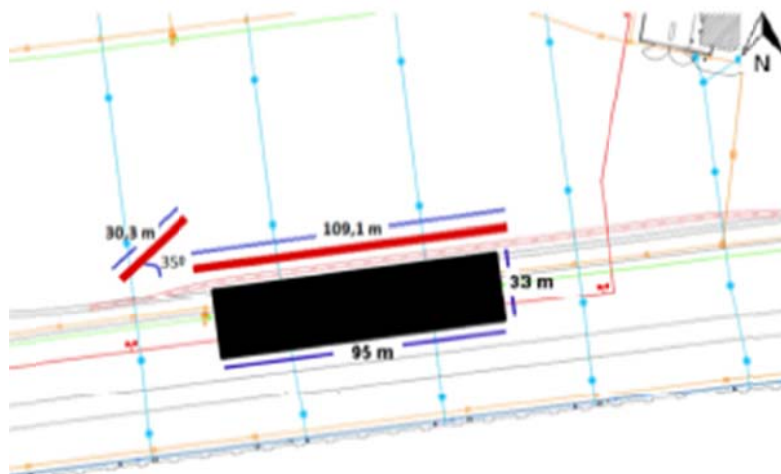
Dimensionamento e localização da barreira [IDAD, 2016]
